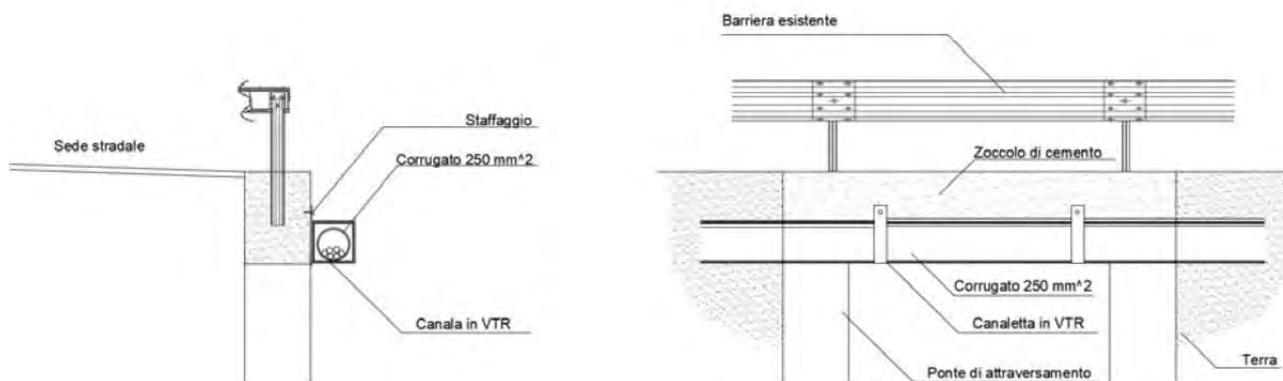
Sezione tipo dello staffaggio del cavidotto ad un ponte stradale
